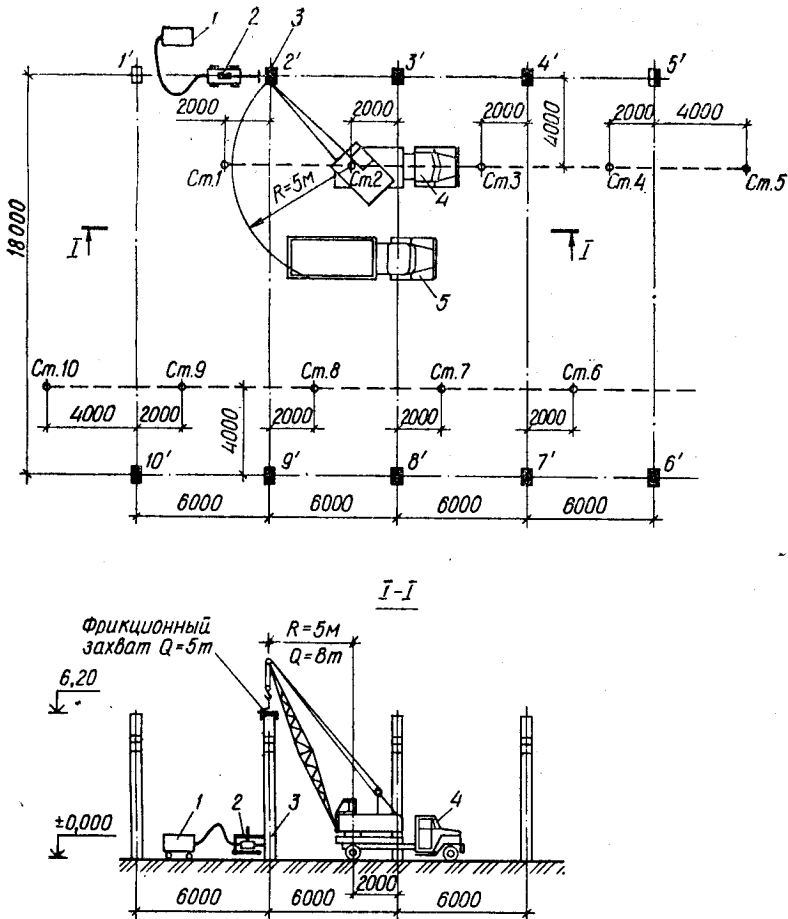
Схема разборки сборных железобетонных колонн каркаса промышленного здания при помощи установки электродугового плавления:
